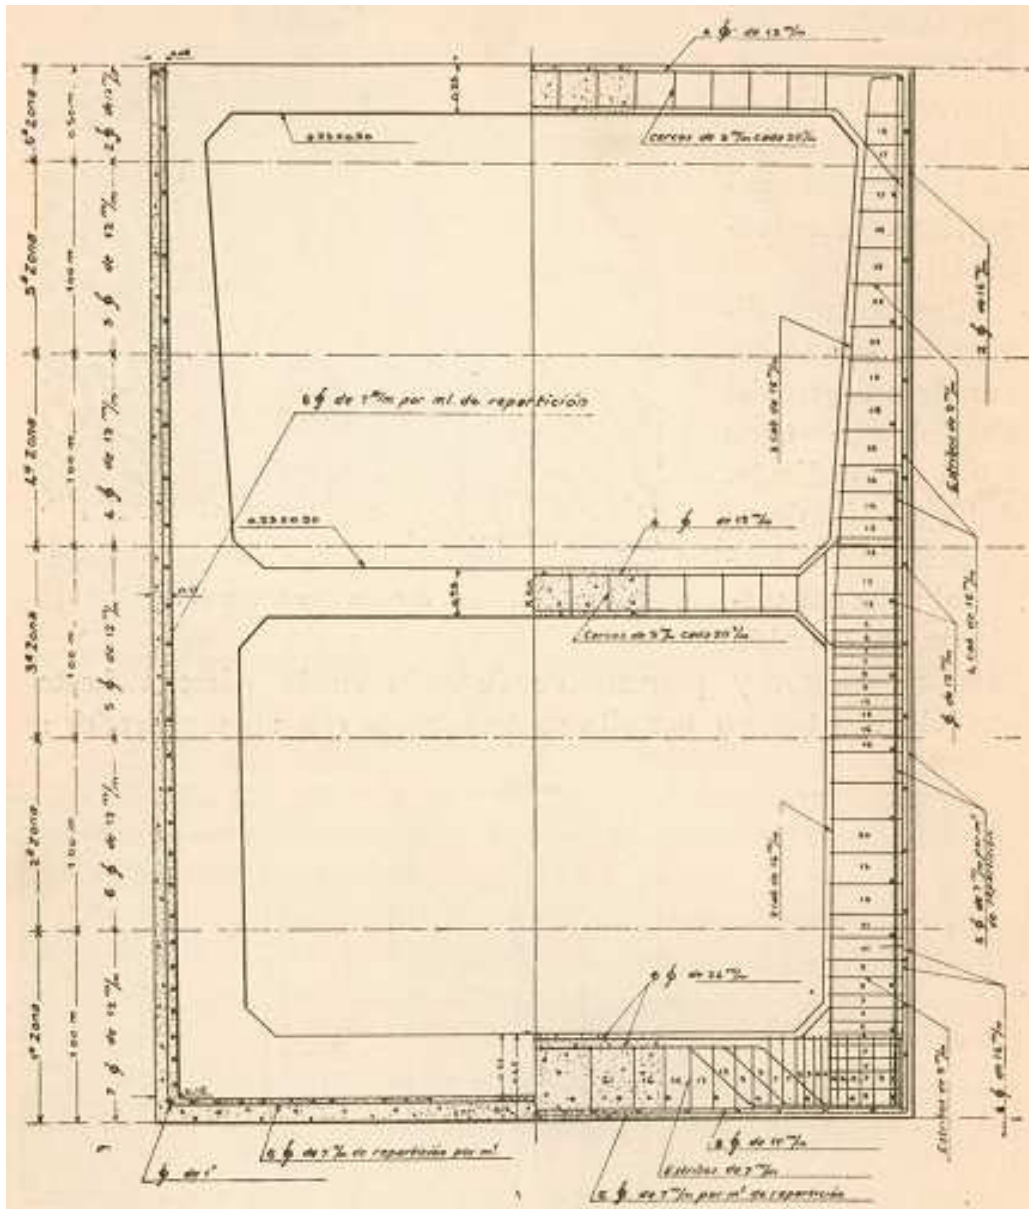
Sección y detalle de armado del cajón utilizado en los muelles de Santa Cruz de Tenerife (Ribera, 1925).
